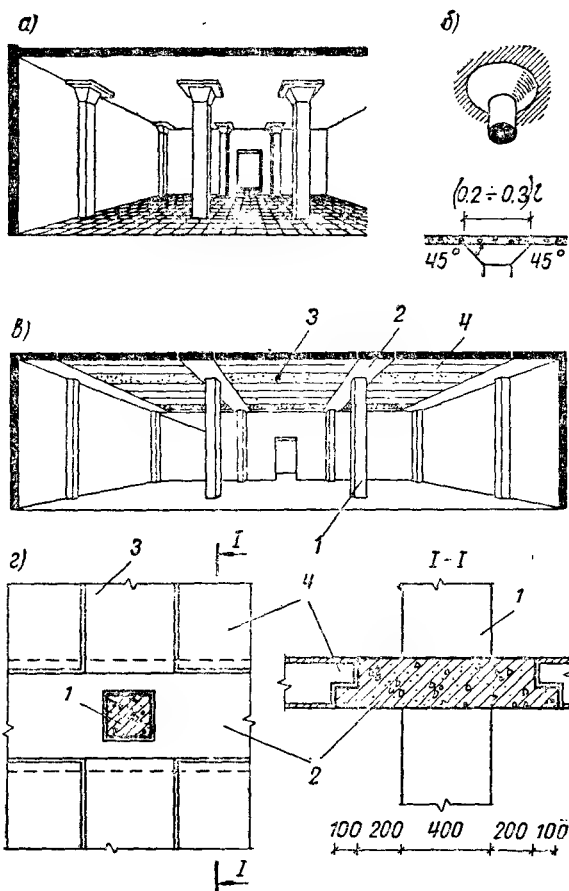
Каркасный остов с безбалочными перекрытиями
